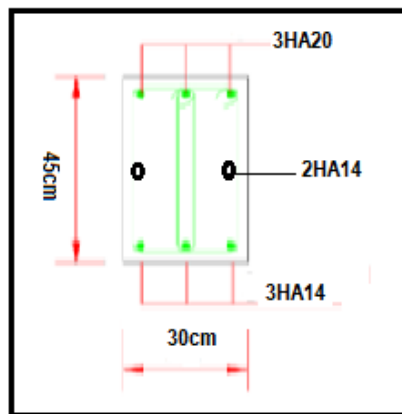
Coupe du schéma de ferrailage des poutres.
